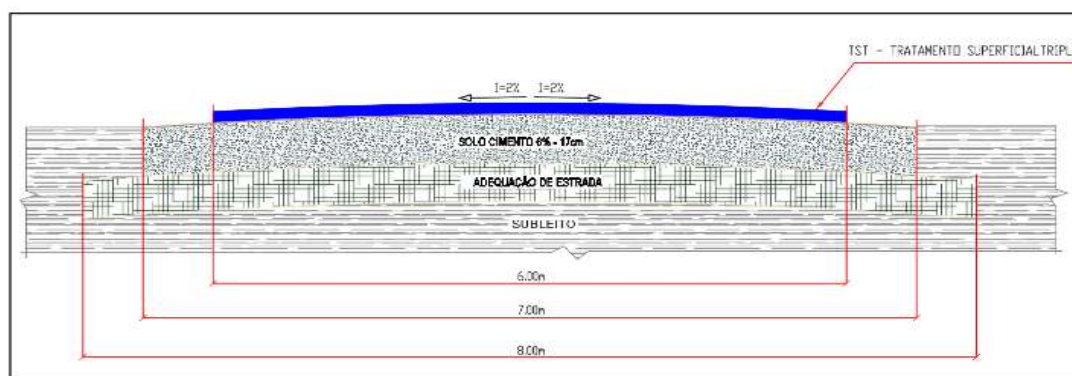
Seção com dimensões do pavimento com base com solo cimento
